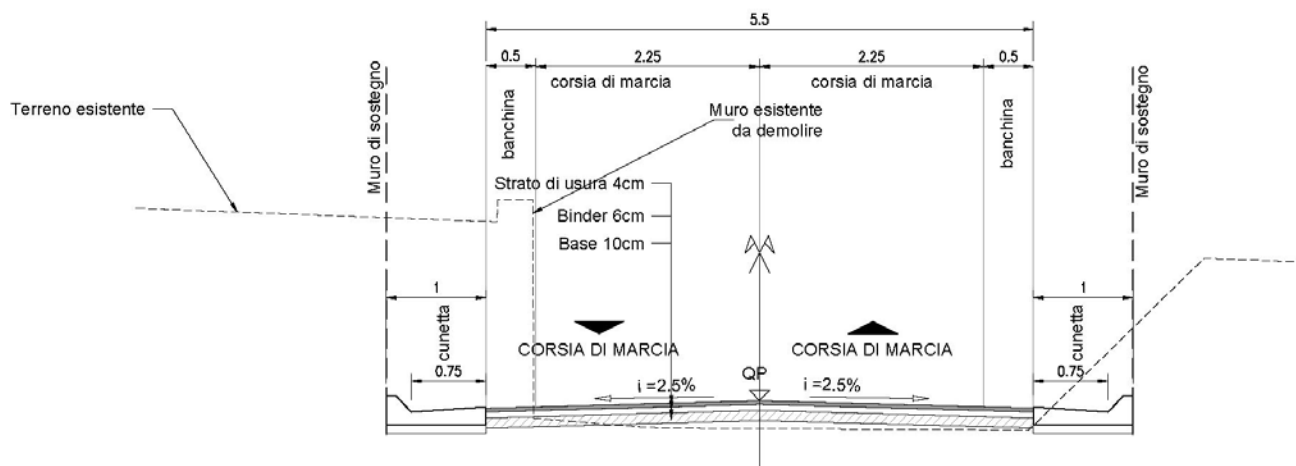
Sezione tipo Ramo Intersezione Tratto viabilità RFI
